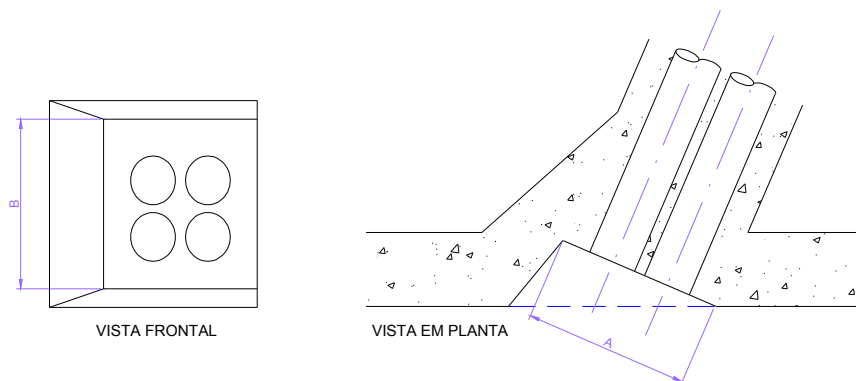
Caixas de inspeção modificada tipo CI-2M (4,00 m x 2,00 m x 2,00 m)
